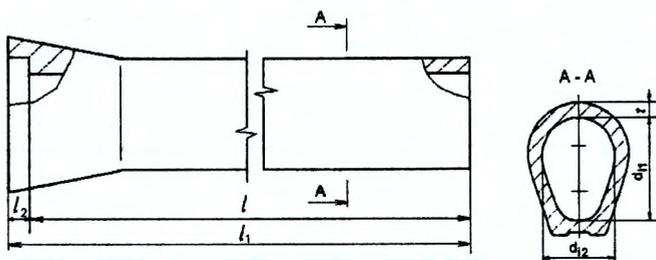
Общий вид труб типа БТО – бетонных раструбных с овалоидальным отверстием
